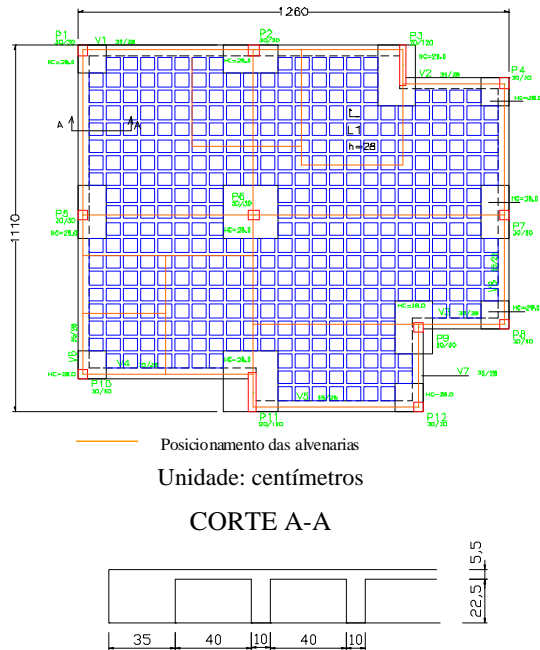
Laje nervurada gerada pelo Modelador Estrutural TQS
